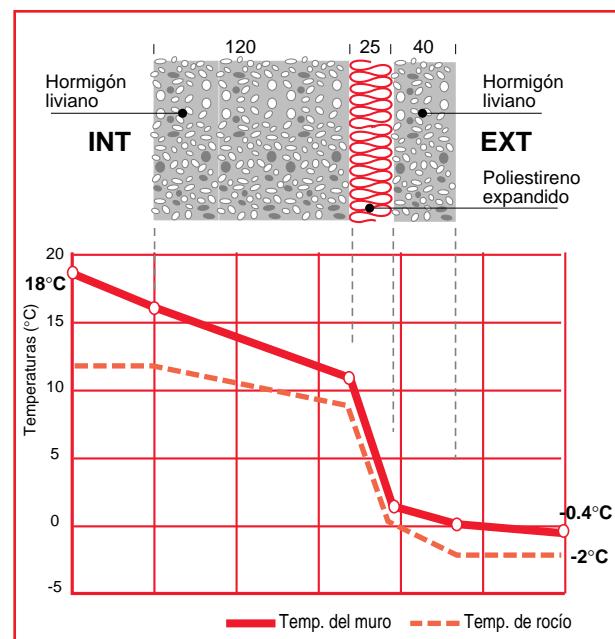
Muro de hormigón liviano sin barrera de vapor.
